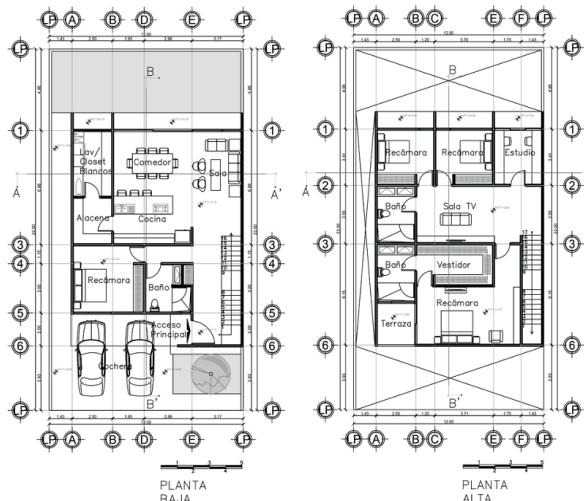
Planta baja y Planta alta del proyecto arquitectónico. S/E. Fuente: Elaboración propia (2024)
